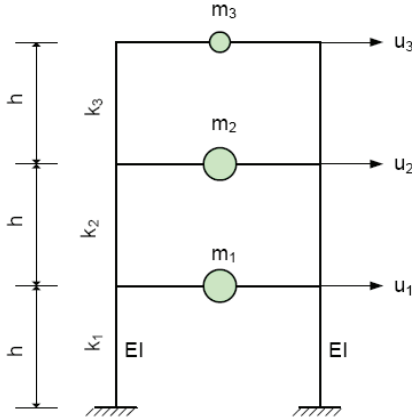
Расчетная динамическая модель здания, работающего на сдвиг
